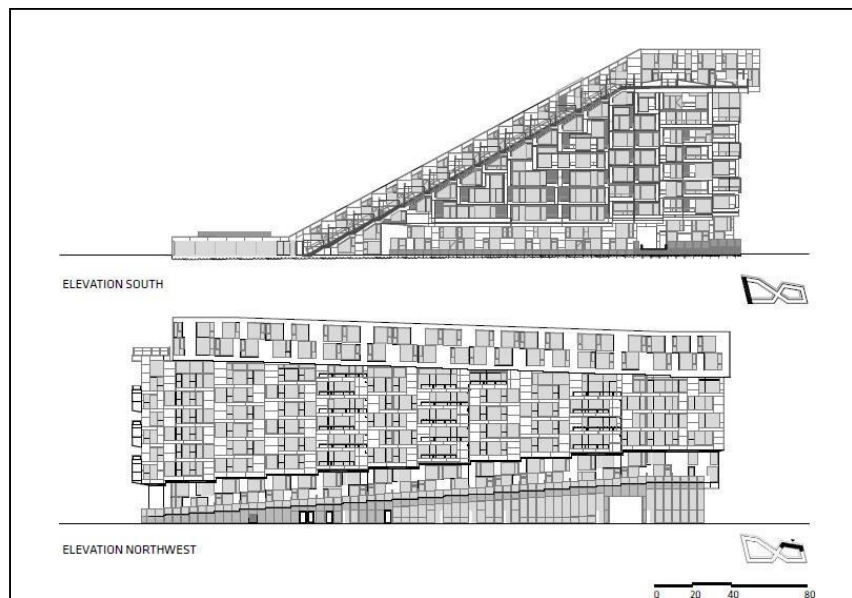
les façades du House 8, source : <https://www.archdaily.com/>
